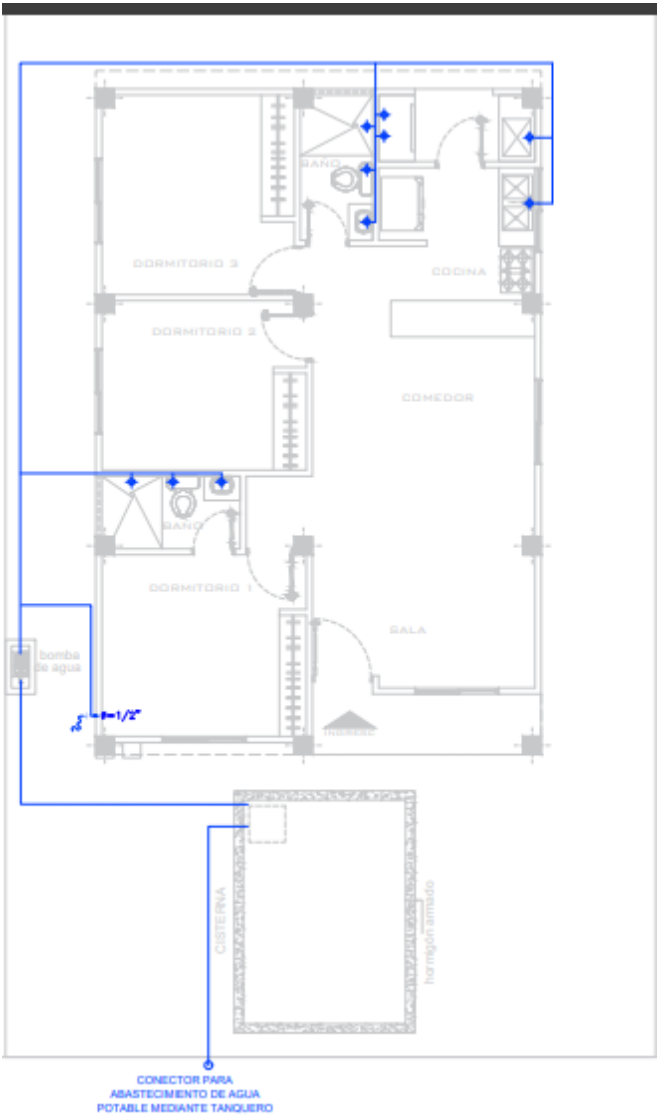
Instalación hidrosanitaria-planta baja. Segunda fase
